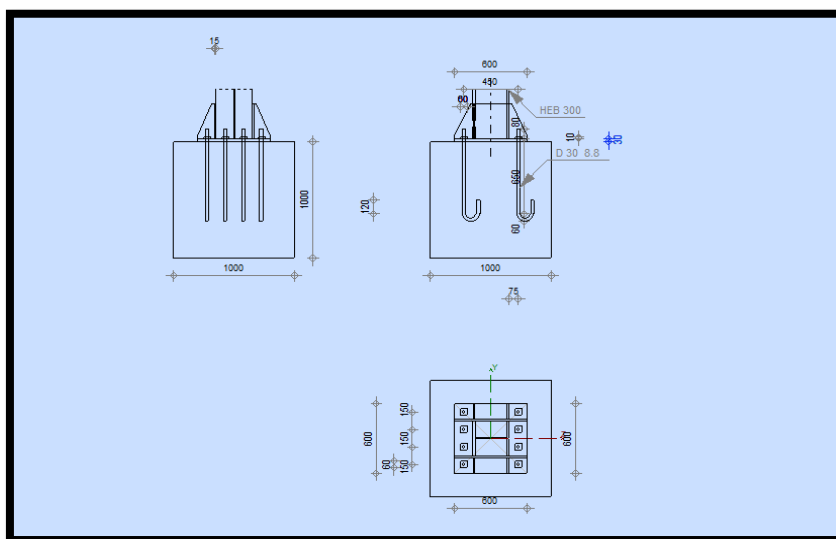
détails sur l'assemblage pied de poteau encastré.
